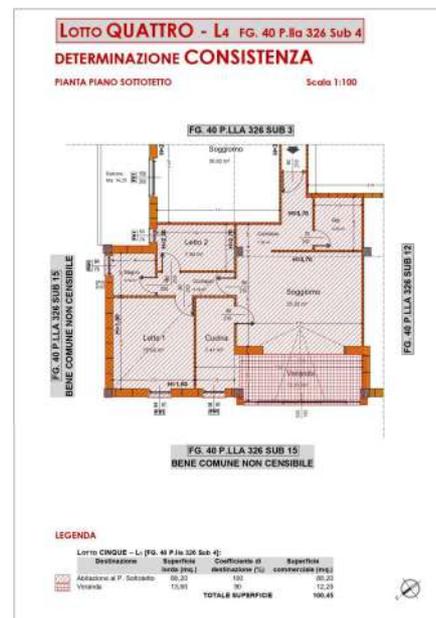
Determinazione consistenza Lotto L4 (ALL. 11).
